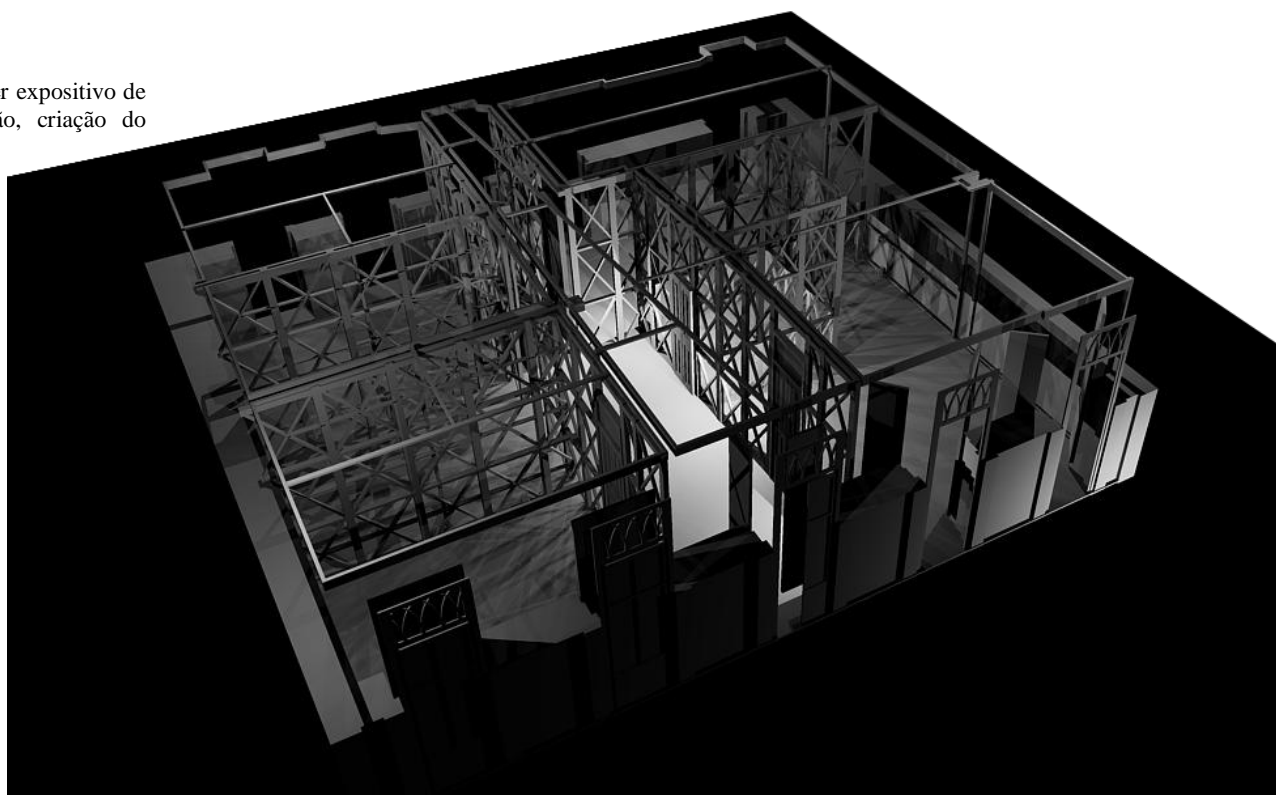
Fotografia de maqueta construtiva vista interiores, criação do autor. Escala 1/50
